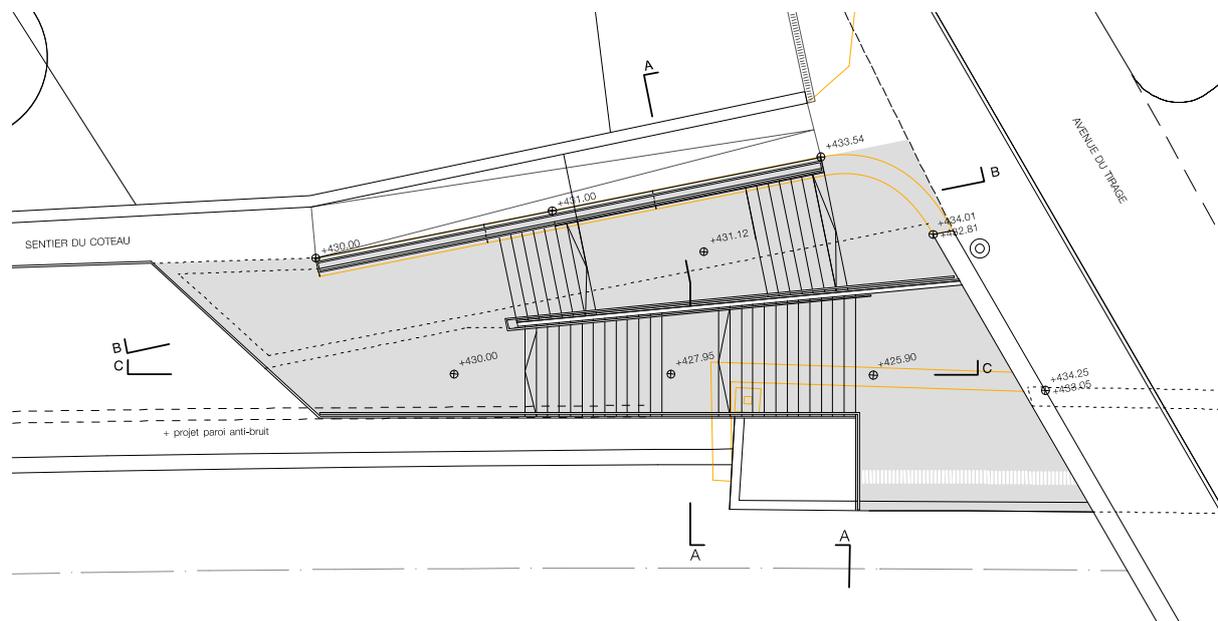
Accès Nord-Ouest _ vue en plan _ échelle : 1/200
